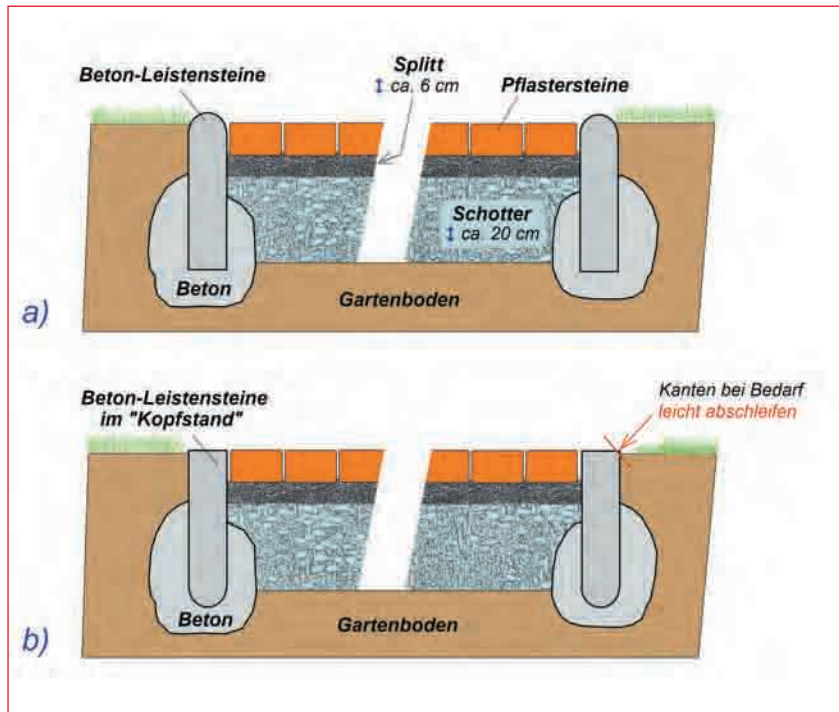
Eine stabile Umrandung eines Gartengrill- oder Sitzplatzes kann u. a. mit Beton-Beetumrandungssteinen errichtet werden: a) Beetumrandungssteine mit runden Kanten nach oben; b) Beetumrandungssteine mit runden Kanten nach unten, damit die Umrandung eine „glatte“ Verbindung zu den Pflastersteinen und dem Rasen bildet.
